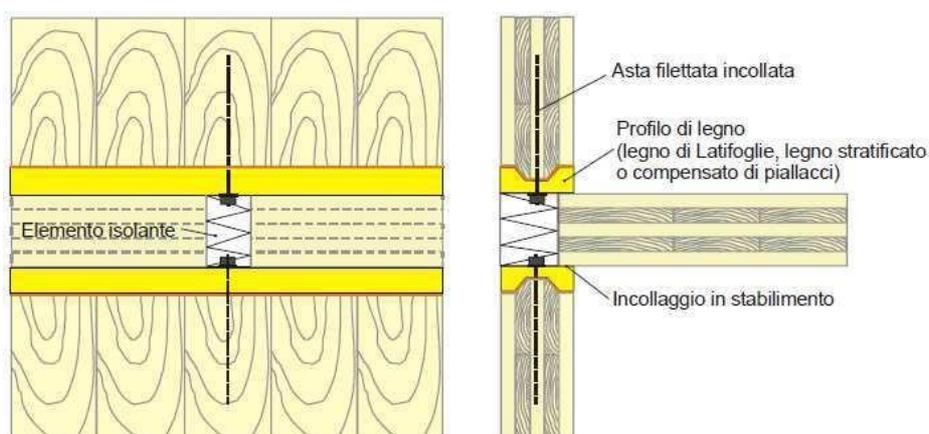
Giunzione parete-solaio-parete con profili di legno.
